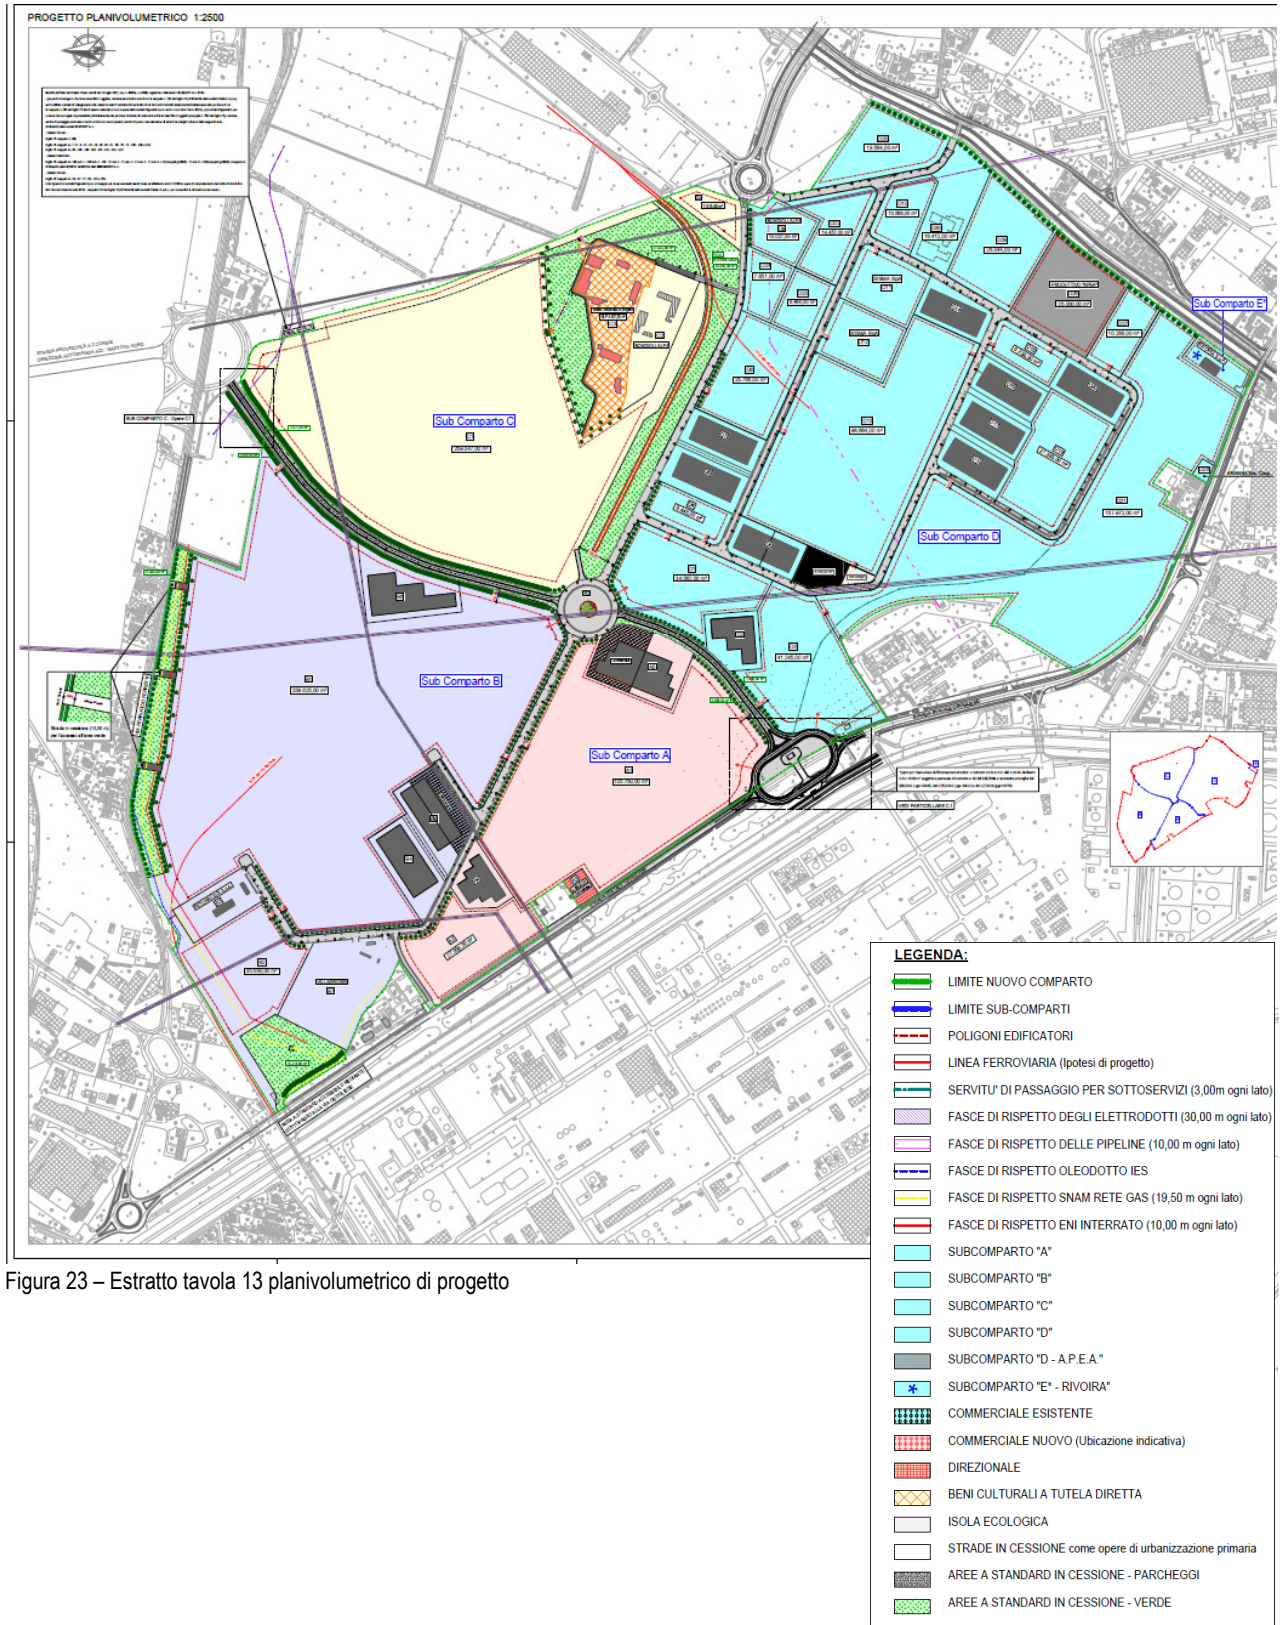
Estratto tavola 13 planivolumetrico di progetto
